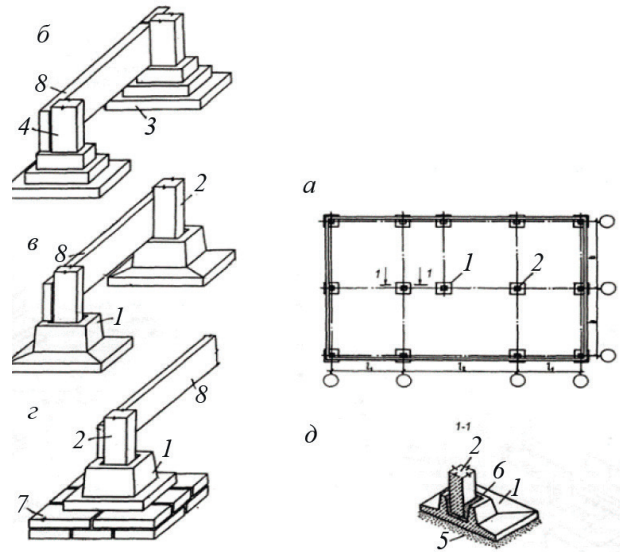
Стовпчасті фундаменти під колони:
